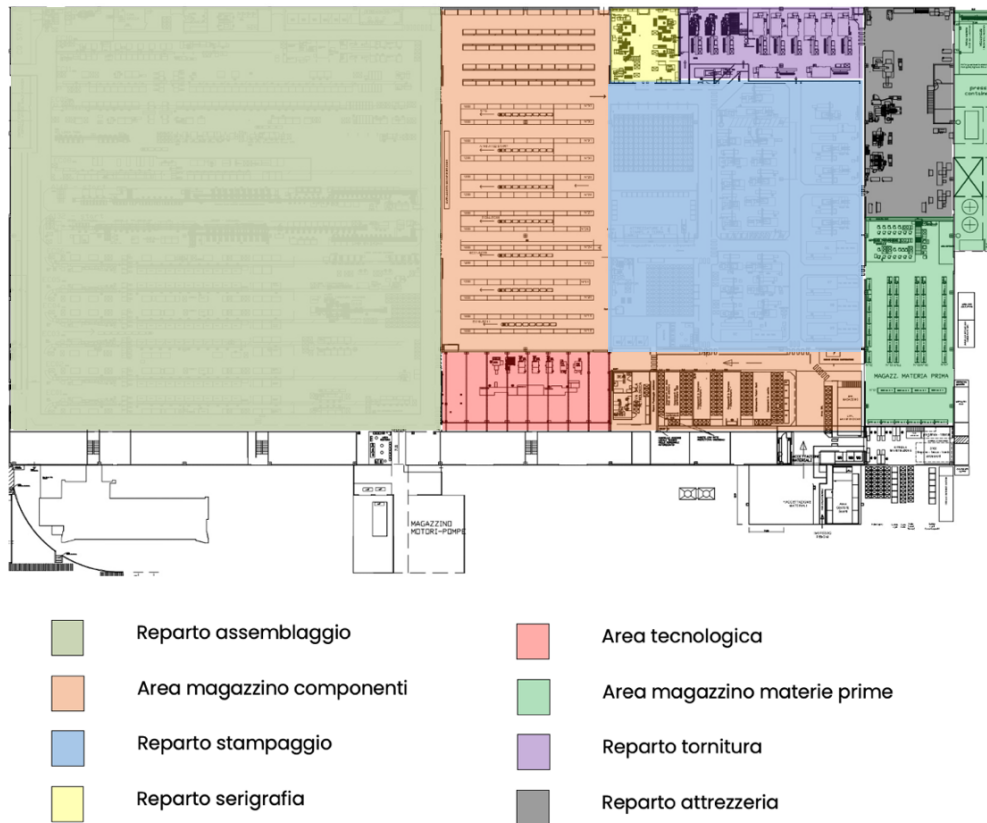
Pianta stabilimento Mignagola (TV)
